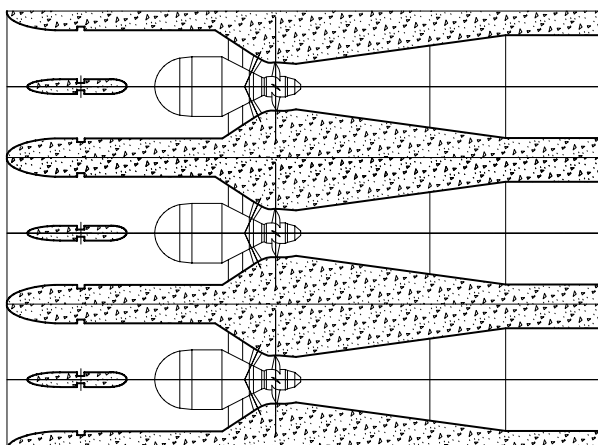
Planta da casa de força – Turbina Bulbo.
